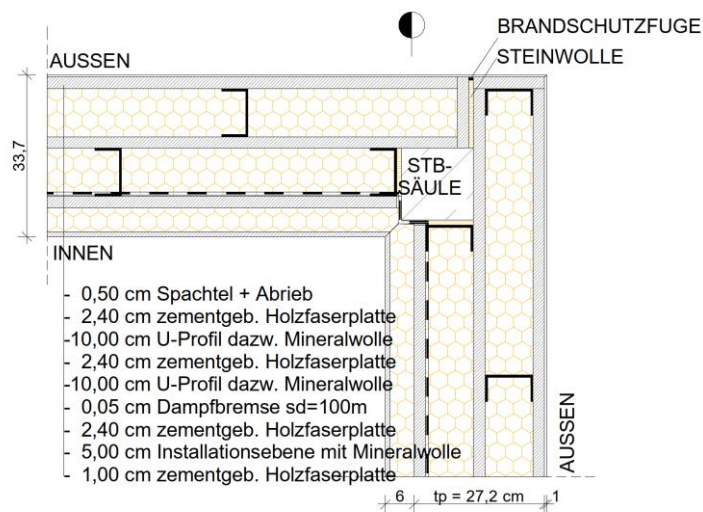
Grundriss Außenecke (mit Stahlbetonecksäule)
